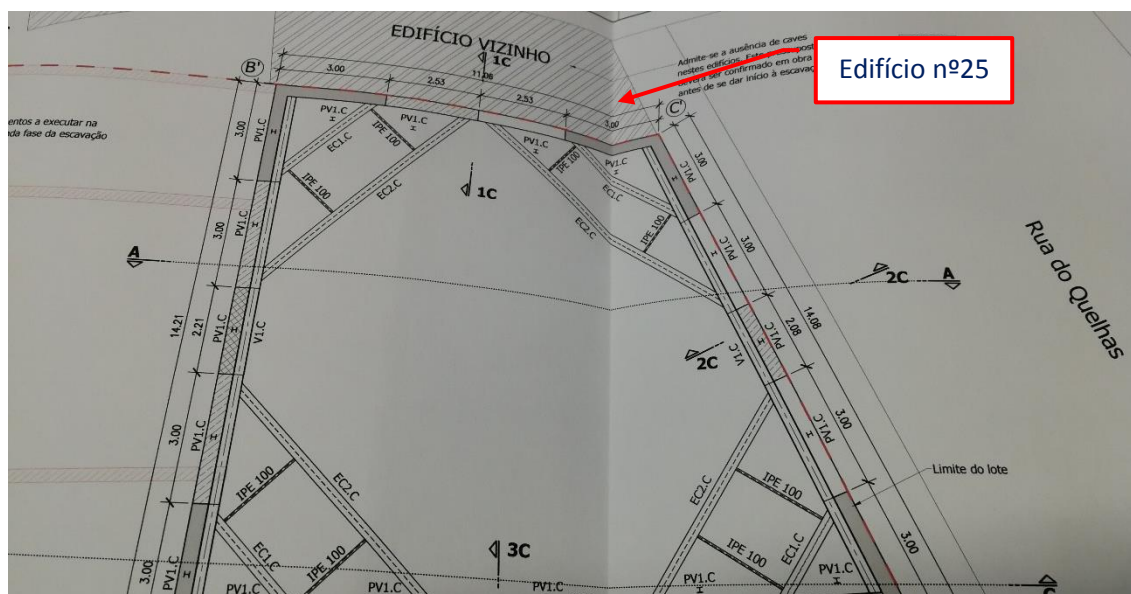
Planta da solução de contenção periférica – 1ª fase
